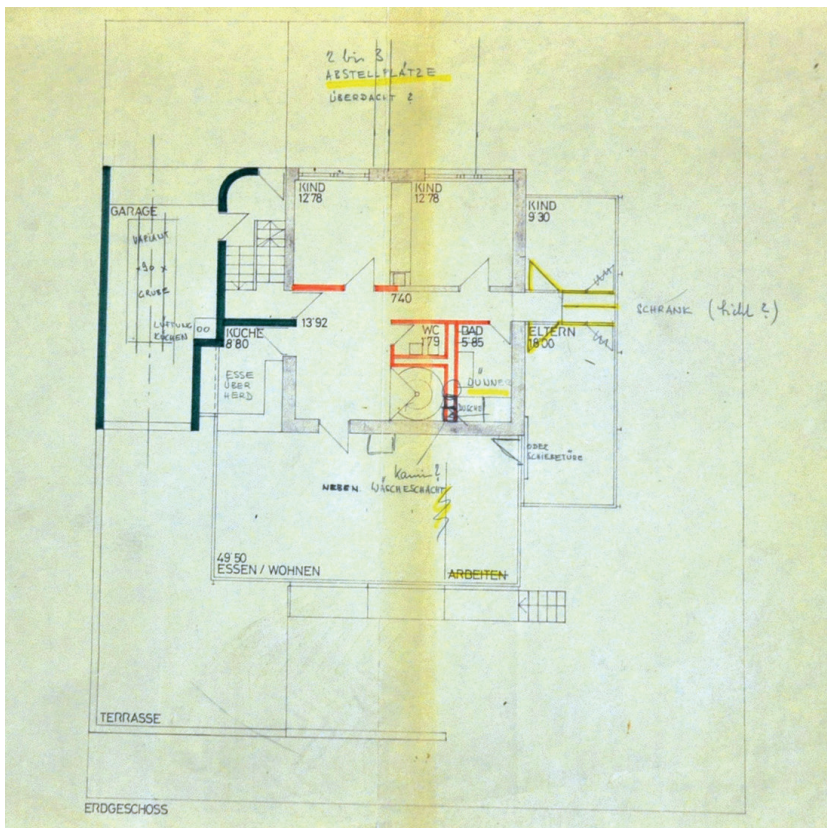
Grundriss Erdgeschoß M:100 (hier skaliert).
